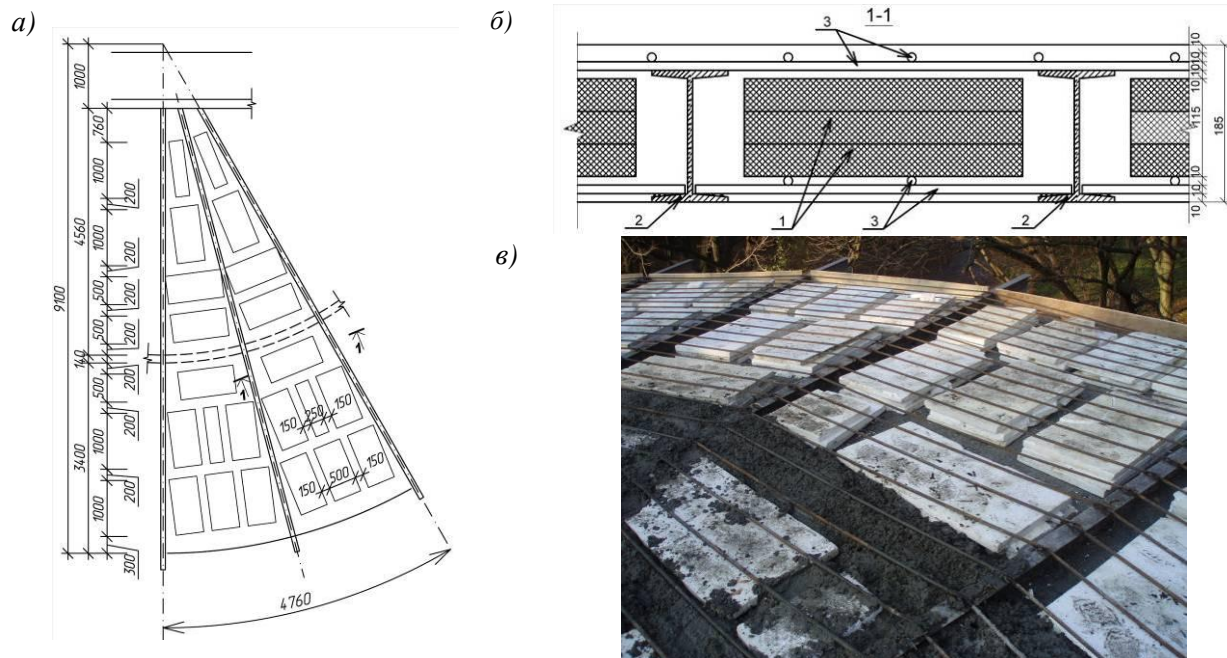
Фрагмент (а), місцевий переріз (б) і бетонування (в) круглого перекриття з пінополістирольними вставками: 1 – пінопластові вставки; 2 – металеві балки; 3 – арматура
